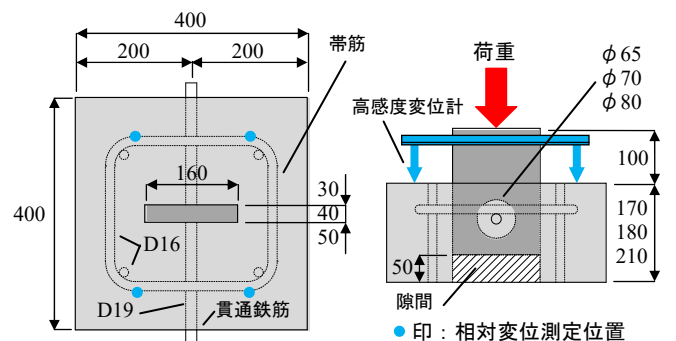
試験供試体の詳細形状と相対変位の測定位置 (単位: mm)
